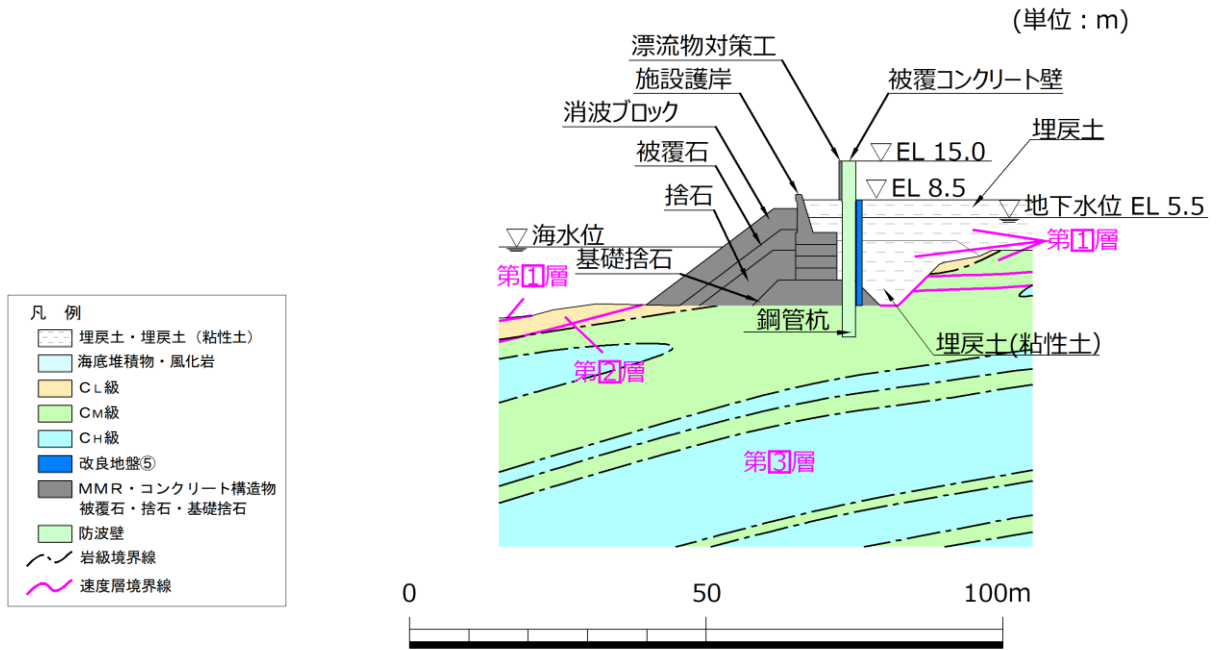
防波壁（多重鋼管杭式擁壁）の横断面図（①-①断面）
